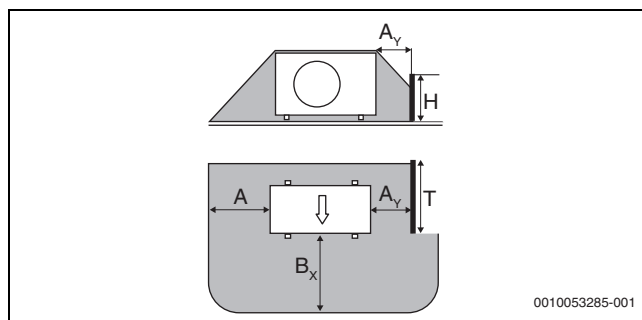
Schutzbereich mit Barriere rechts, bodenstehende Wärmepumpe
